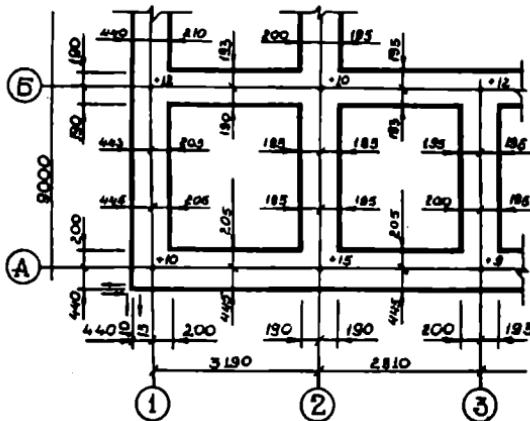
Фрагмент исполнительной схемы кирпичной кладки под перекрытие этажа
